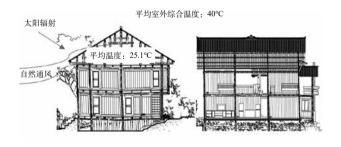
传统民居立面图及其剖面图 (由同济大学城规学院提供)
